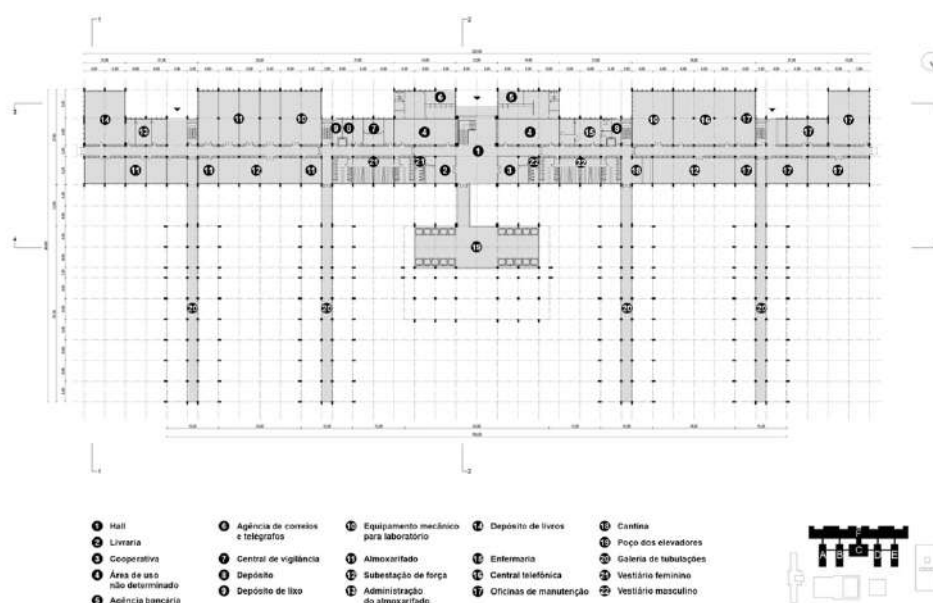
Pavilhão João Lyra Filho - Planta Baixa Pavimento Semienterrado.
